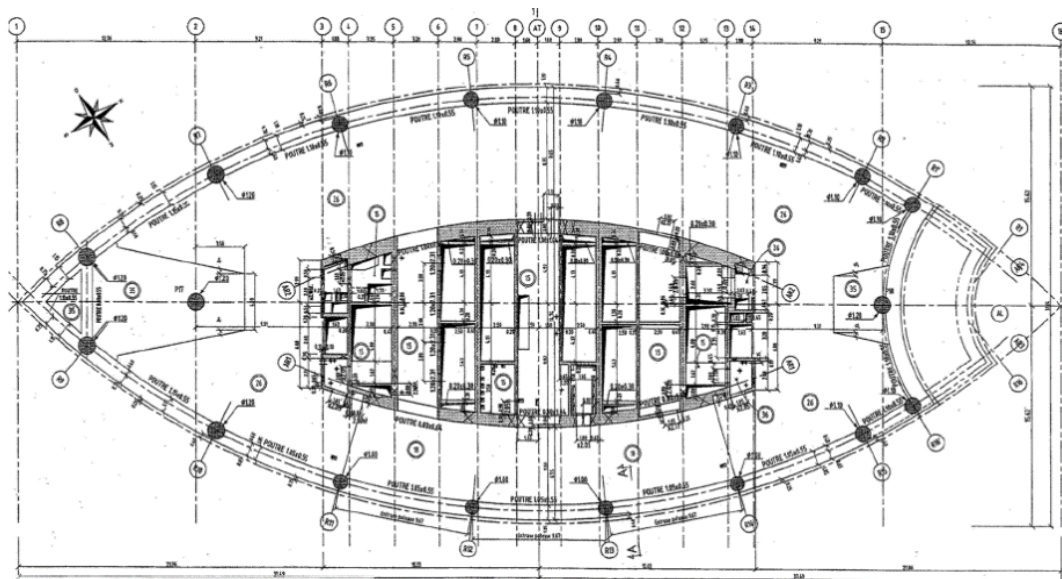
Plan d'un niveau de la tour EDF de la défense
